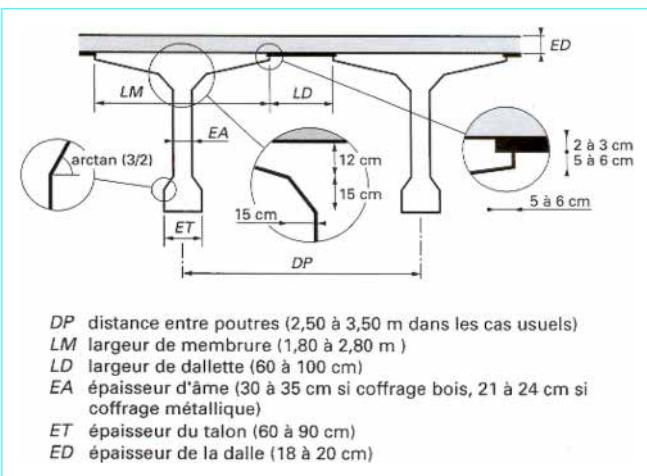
Dimensionnement des ponts à poutres en béton précontraint
